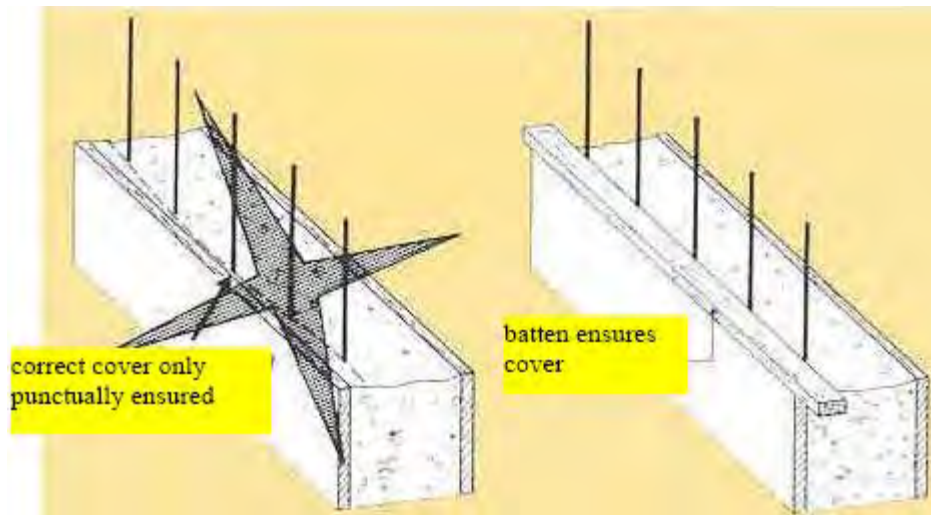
Unzureichende Lagesicherung führt zum Unterschreiten der Betondeckung
